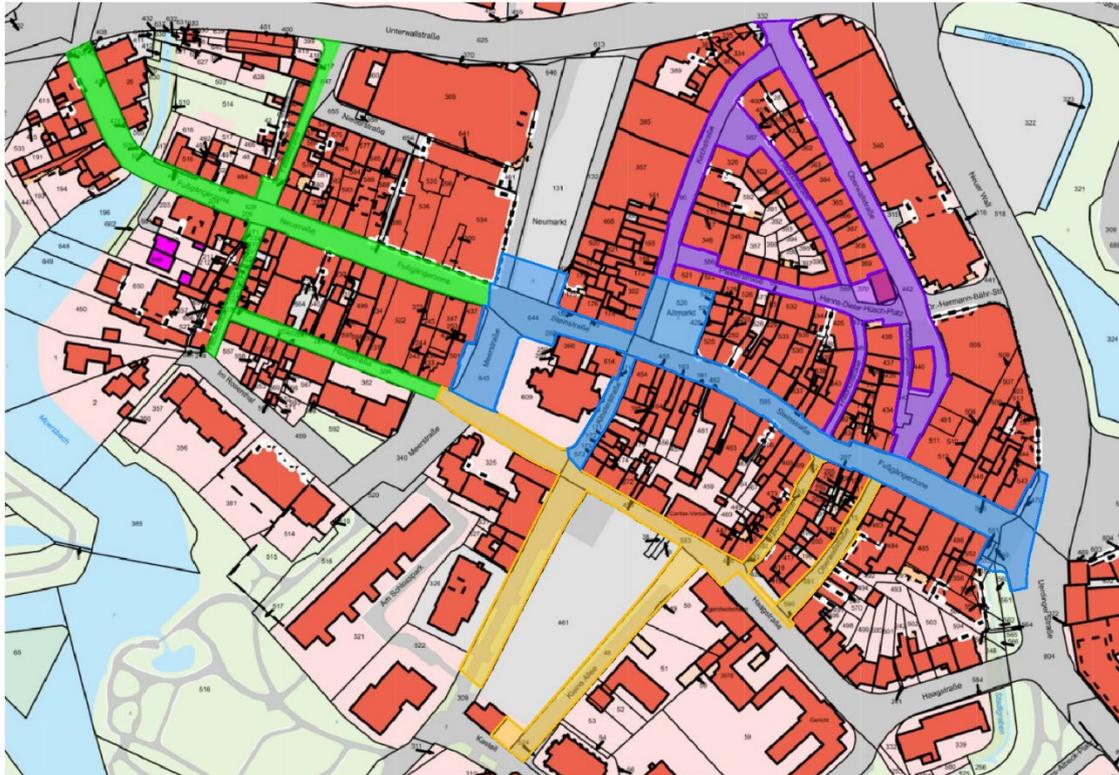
Lageplan Projektgebiet Innenstadtumbau mit Bauabschnitten
